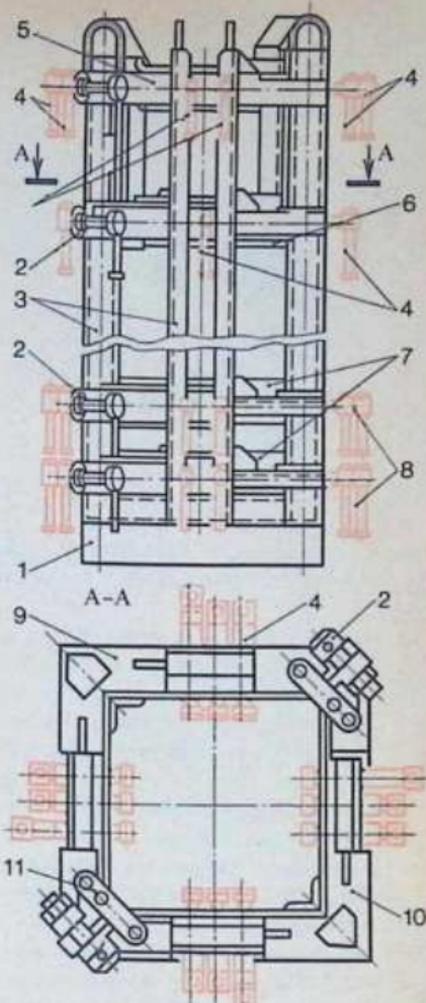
Одиночный кондуктор для закрепления и выверки колонн:
